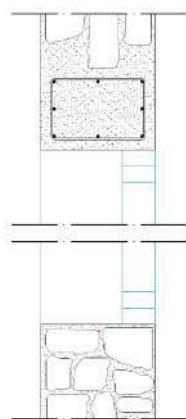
Dintel en muro de mampostería. 2016. Fuente Propia
